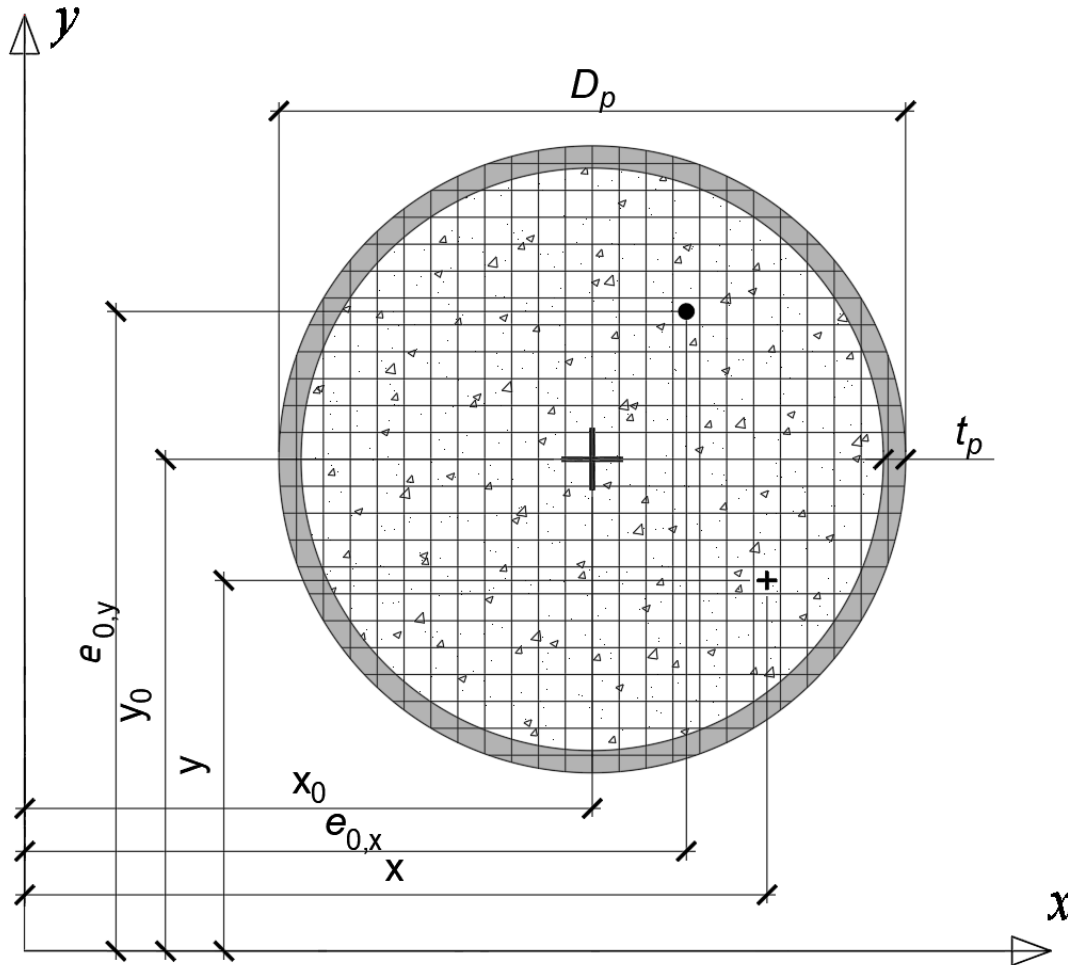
Расчетное поперечное сечение внецентренно сжатого трубобетонного элемента
